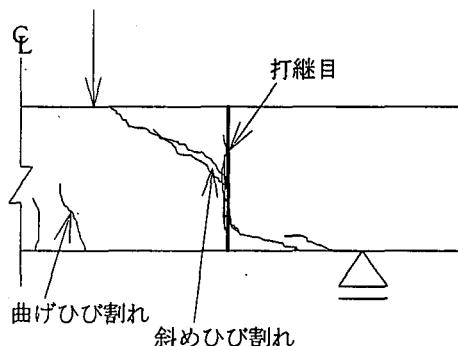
せん断スパン中央に鉛直打継目を有するRCはりの破壊時におけるひび割れ状況
